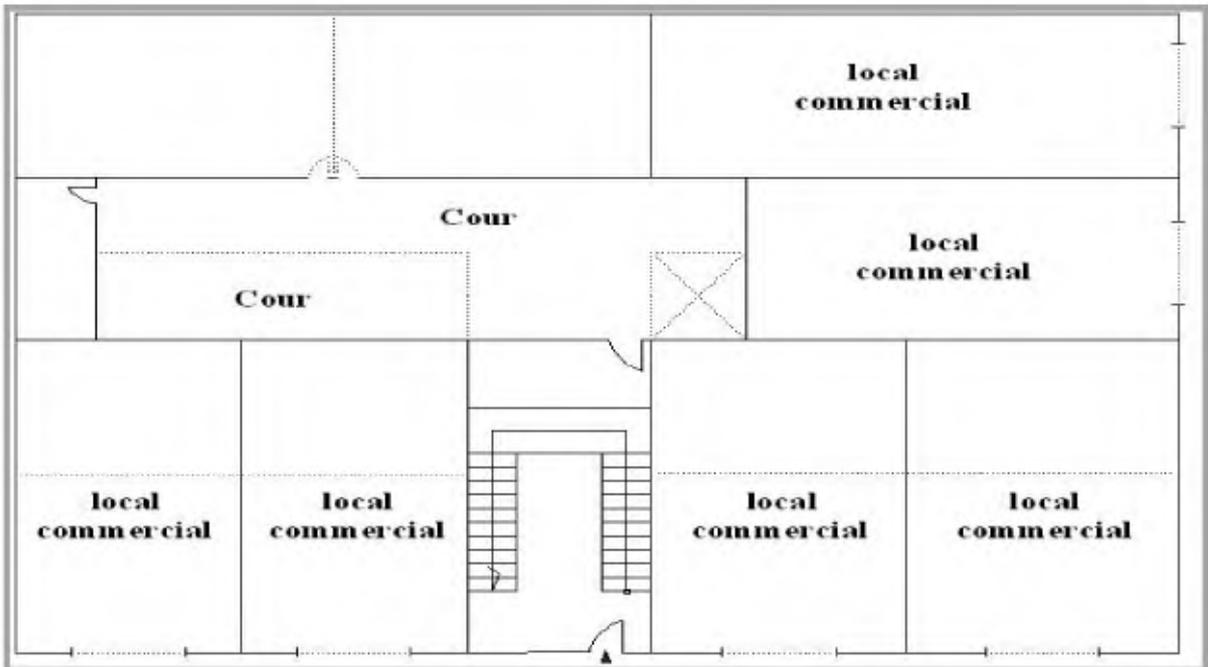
Plan du rez-de-chaussée de l'immeuble étudié (en pointillé les transformations récentes)
